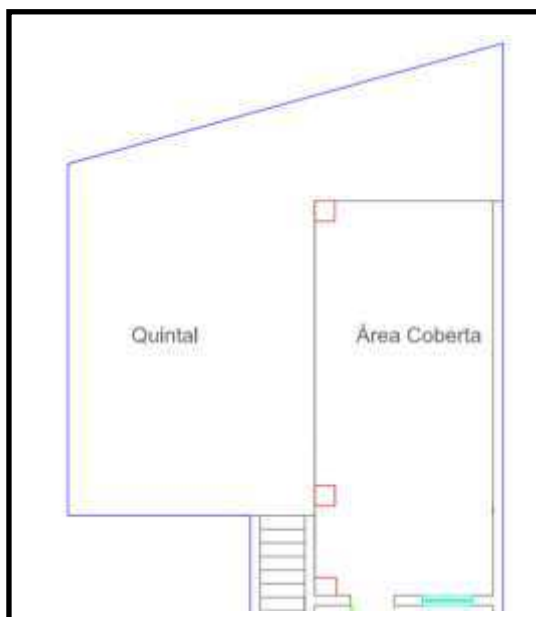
Detalhe externo da edificação – Localização do Quintal
